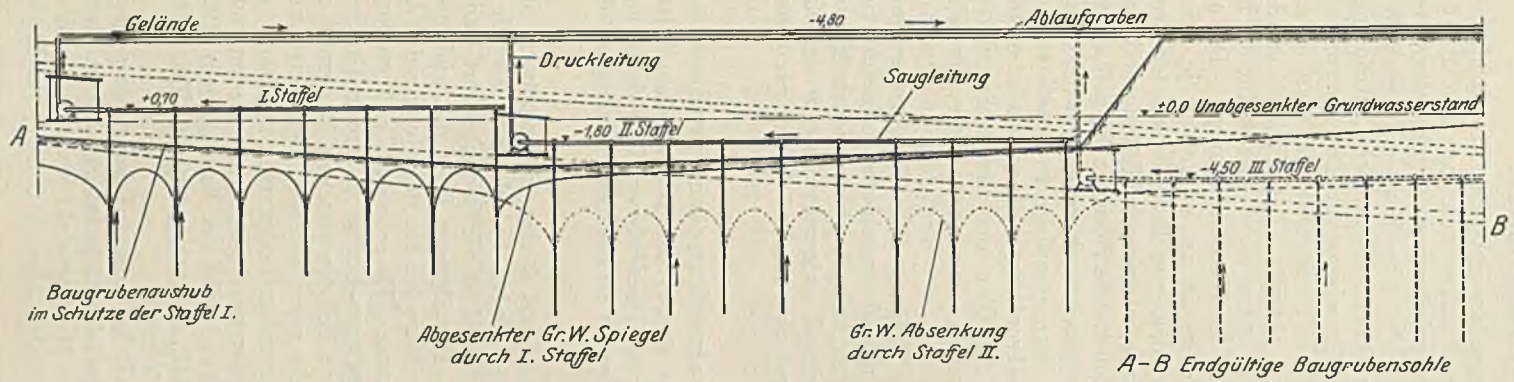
Stufenweise Staffelung bei einer Untergrundbahnrampe.
